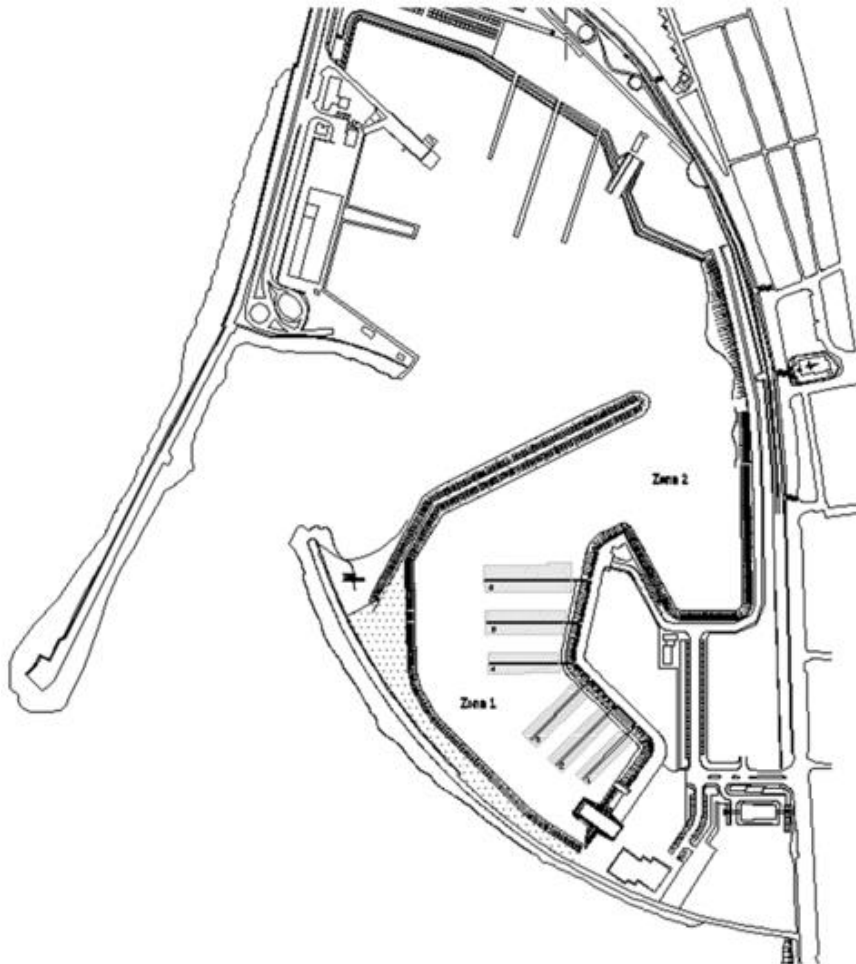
Planta de Situação Marina de Póvoa do Varzim (Fonte: [4])
